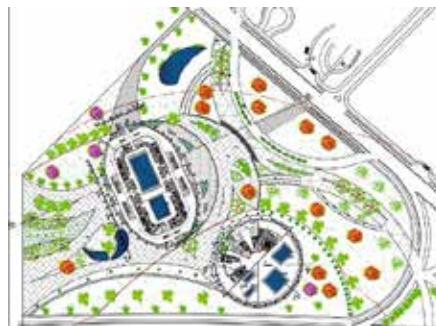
Planta baja, edificación enseñanza, nivel + 1.00 (2019)
